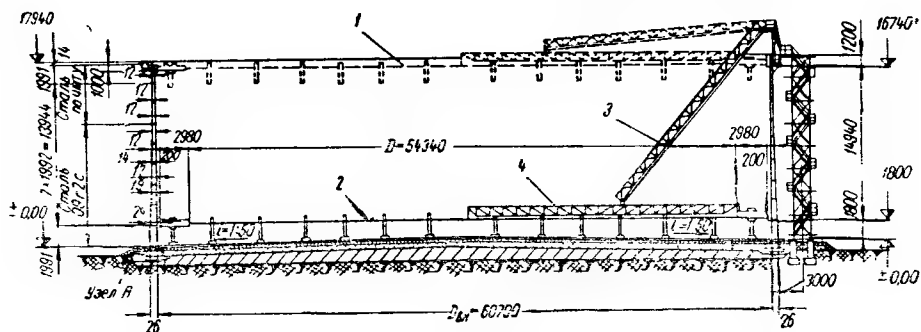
Резервуар с плавающей крышей емкостью 50 тыс. м^3 (ЦНИИПроект-
